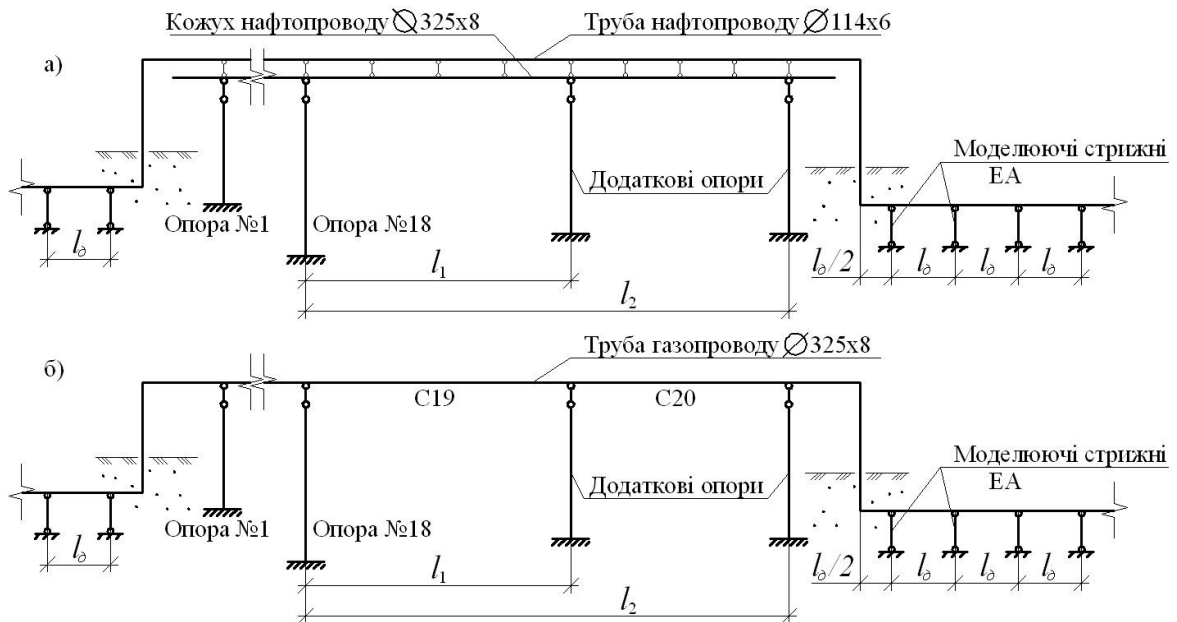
Розрахункові схеми переходу після реконструкції (прольоти між опорами № 1 та № 18 умовно не показані): а) нафтопроводу; б) газопроводу
